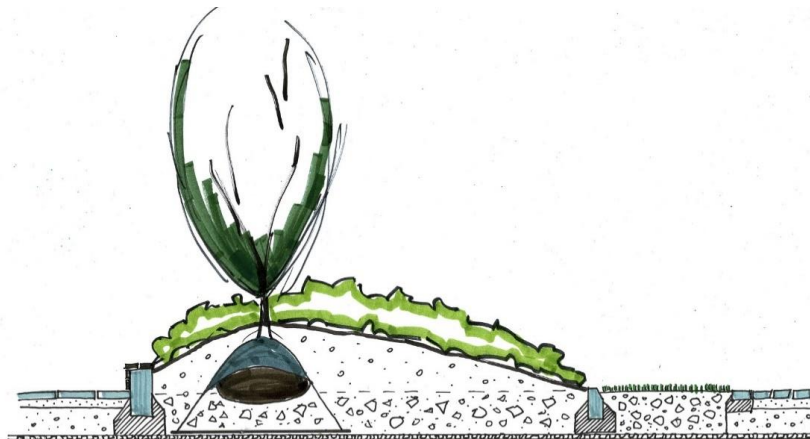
Coupe de principe d'un îlot de plantation sur dalle réalisée par le bureau Green Surf
